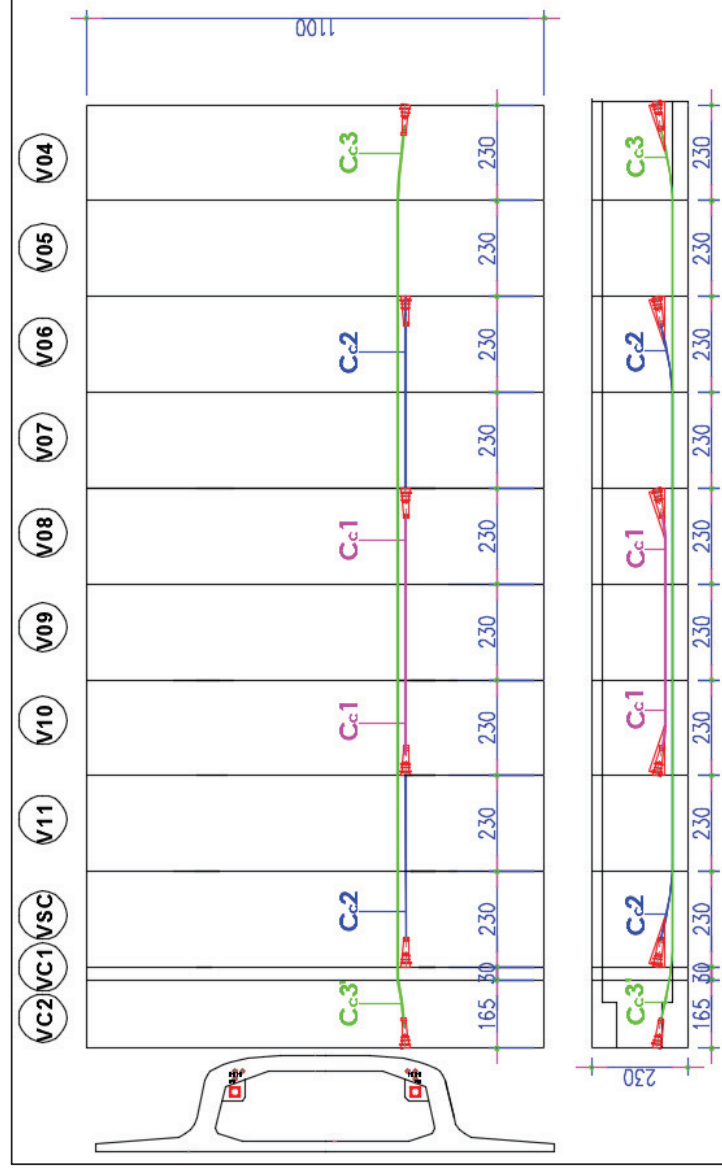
Tracé en élévation et en plan des câbles de continuité pour les travées de rives.
